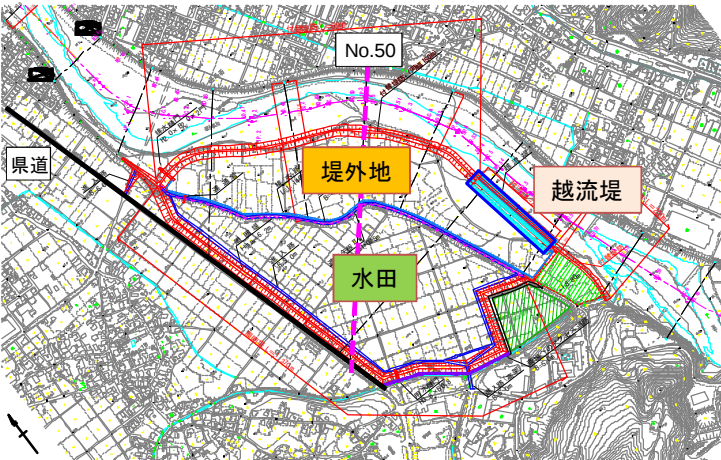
遊水地（5.6k 左岸）平面図
